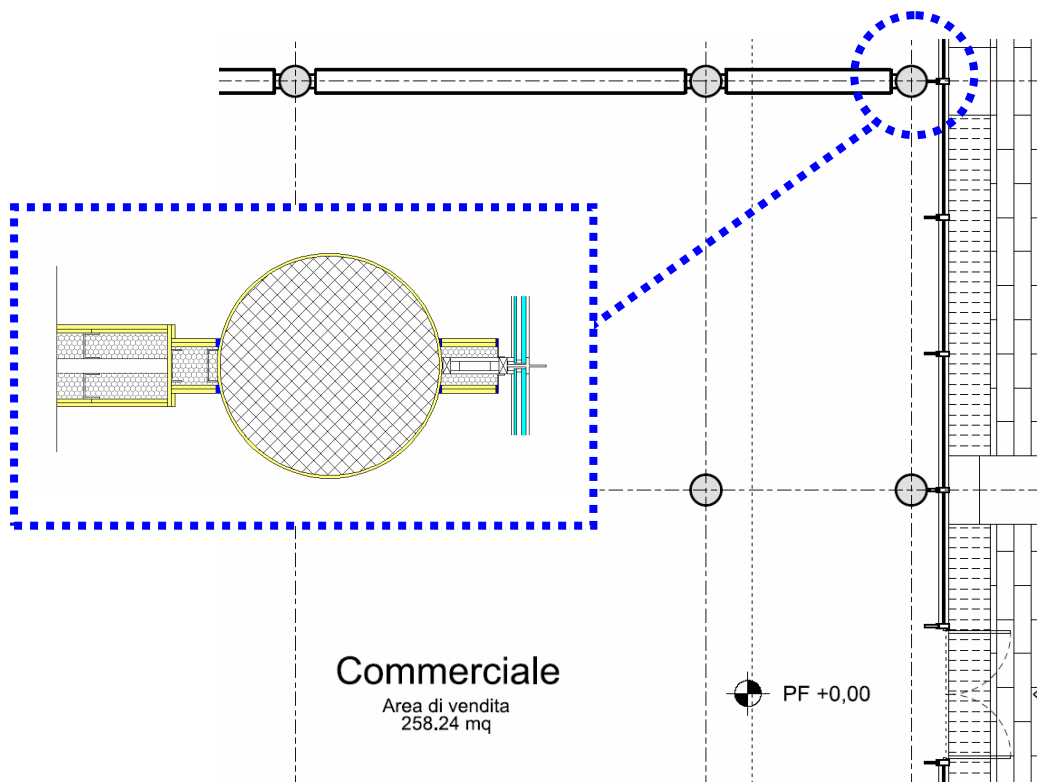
Indicazione in pianta degli elementi leggeri di facciata non rigidamente connessi
